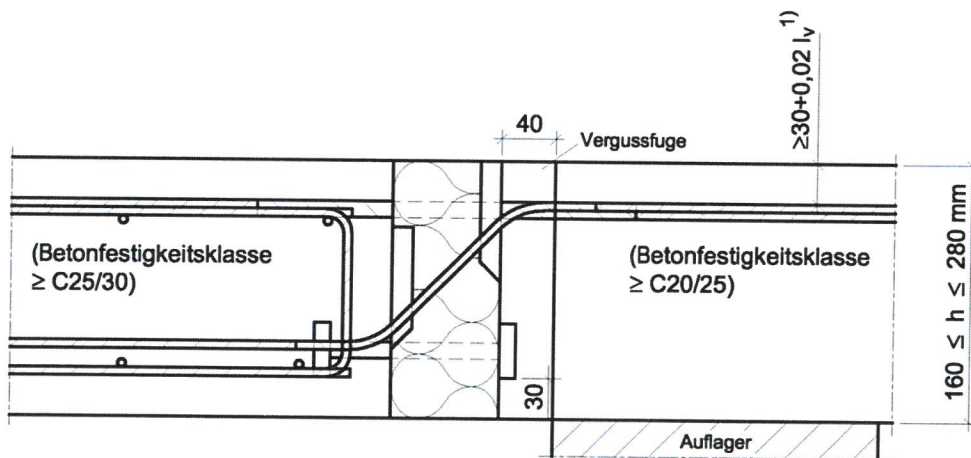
Beispiel Schöck Isokorb Typ RK-239 in eingebautem Zustand mit Vertikalbewehrung nach Abschn. 3.3.1, Z-15.7-239 und Vergussfuge
